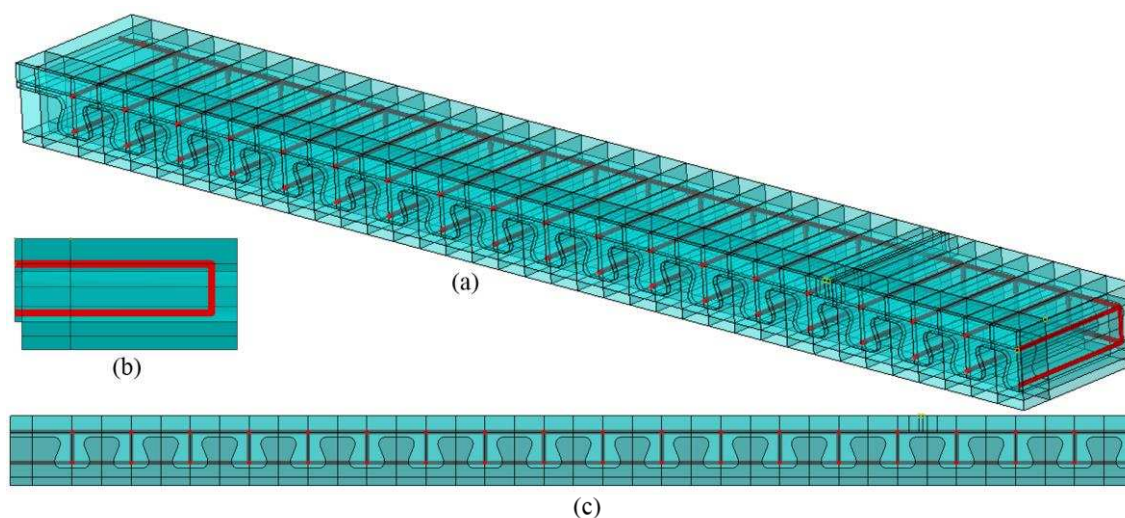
Interação tipo *embedded* entre a armadura e a laje: (a) perspectiva; (b) vista da seção transversal; (c) vista lateral.
